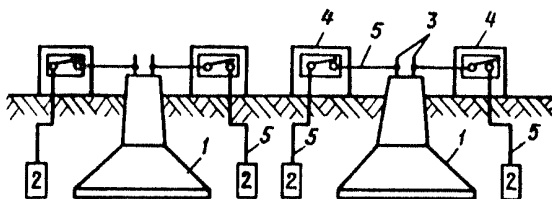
Схема протекторной защиты арматуры фундамента опоры ВЛ:
